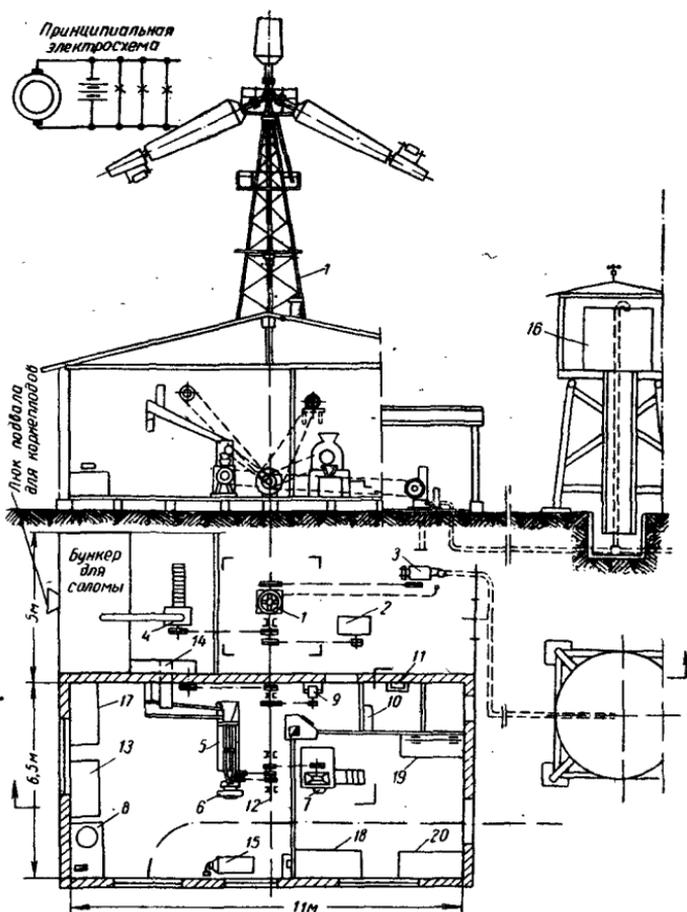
Ветроустановка с ветродвигателем Д-12 для привода машин кормового цеха:
